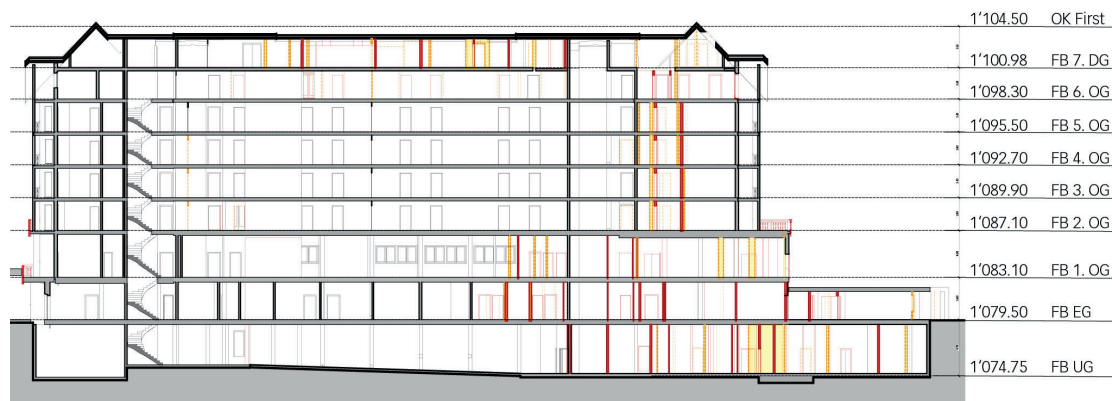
Längsschnitt durch das bestehende Hotel mit Geschossen und Angabe der Kote des jeweiligen fertig Bodens
